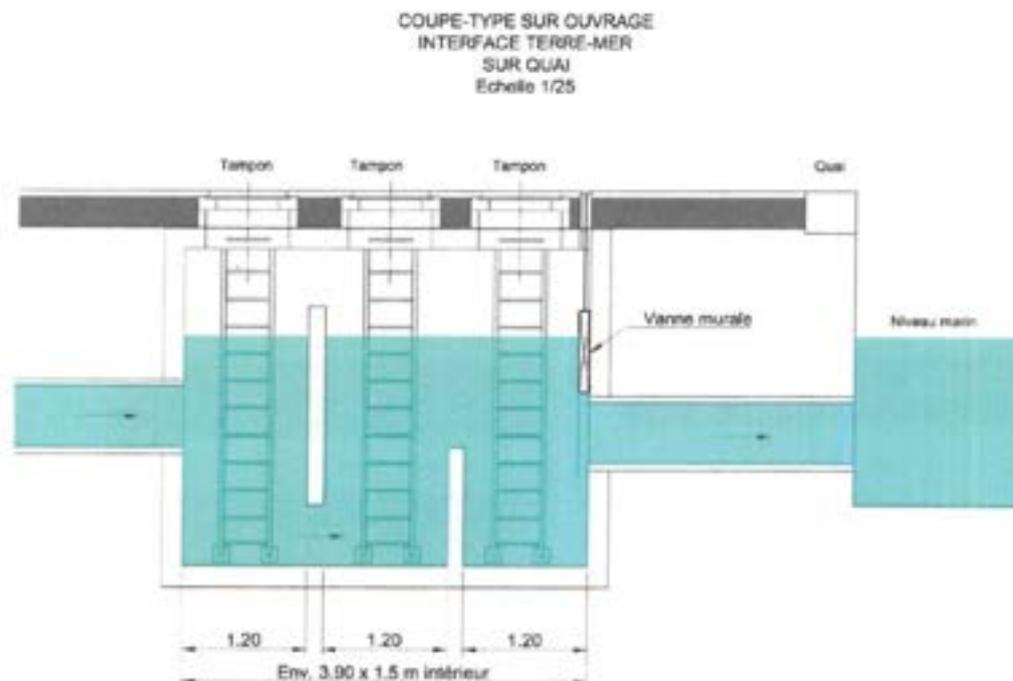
COUPE TYPE SUR OUVRAGE INTERFACE TERRE-MER SUR QUAI
